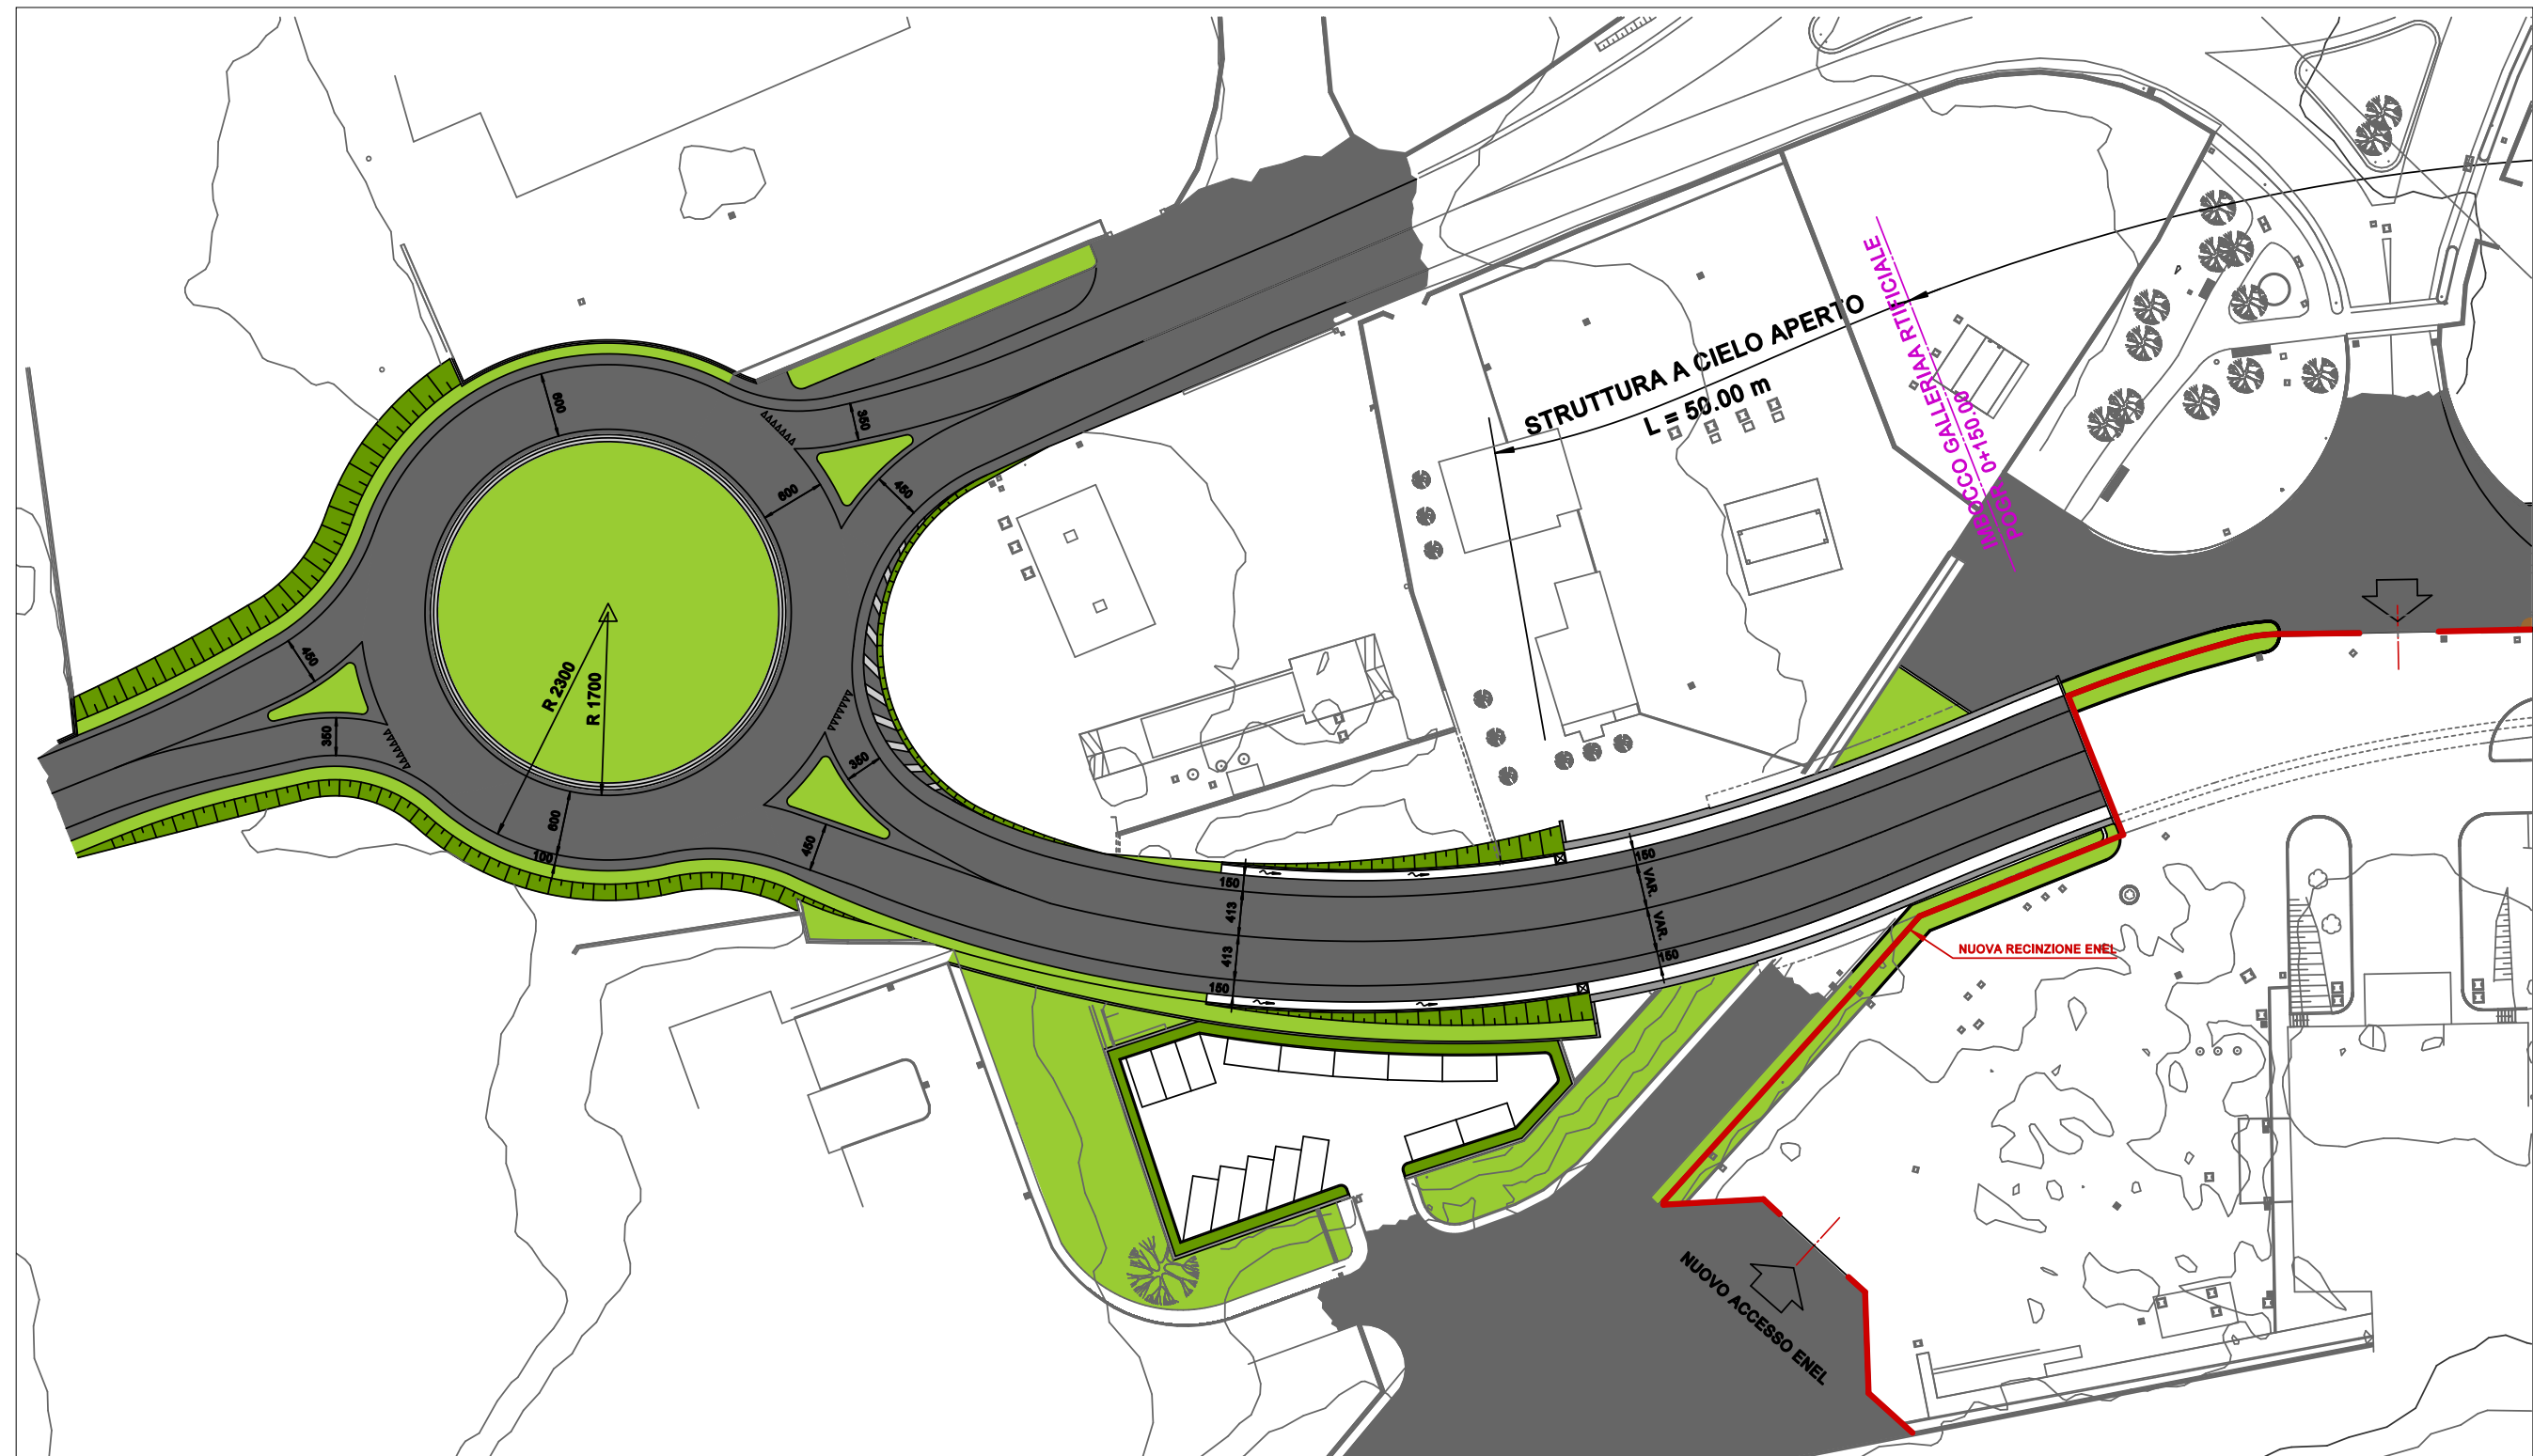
Stralcio planimetrico del tratto iniziale della Variante
